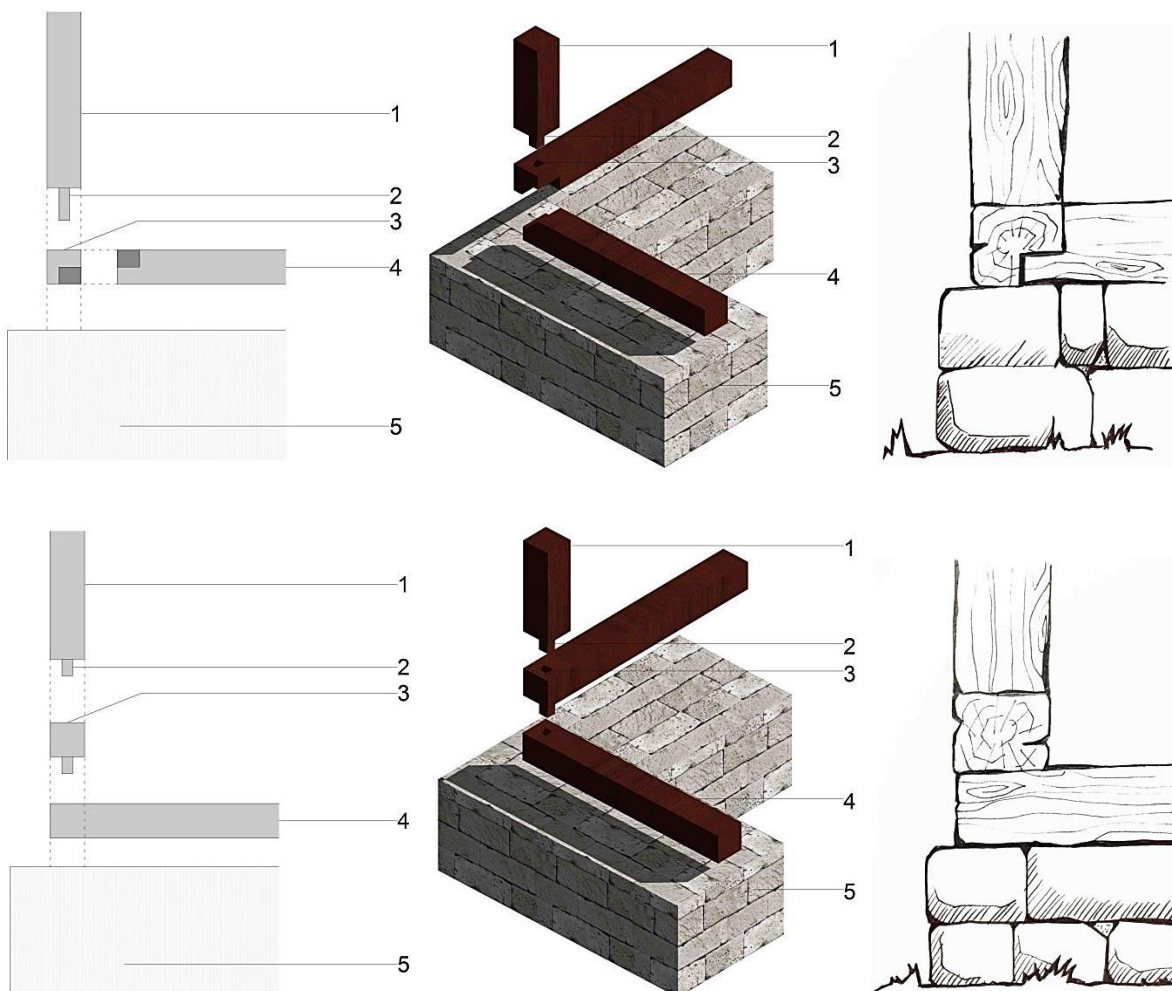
Detalles de ensambles entre columna y solera. Autor: Paúl Rivas Rivas.
